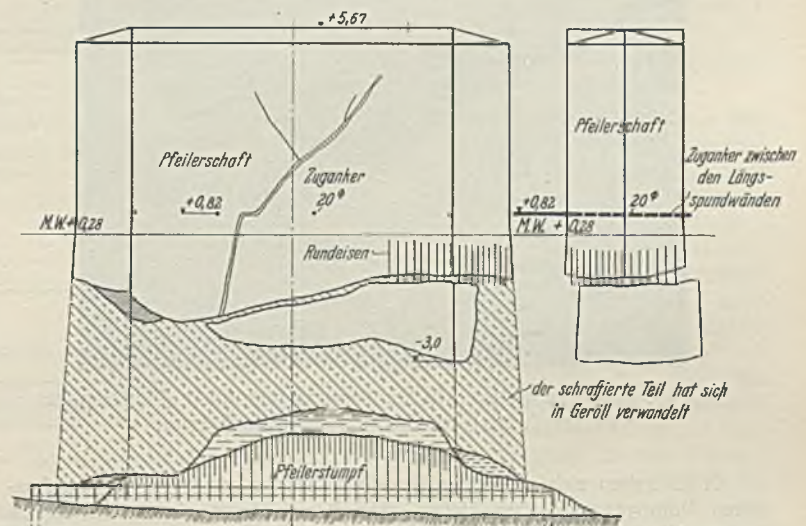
Rekonstruierter wiesenseitiger Strompfeiler.
